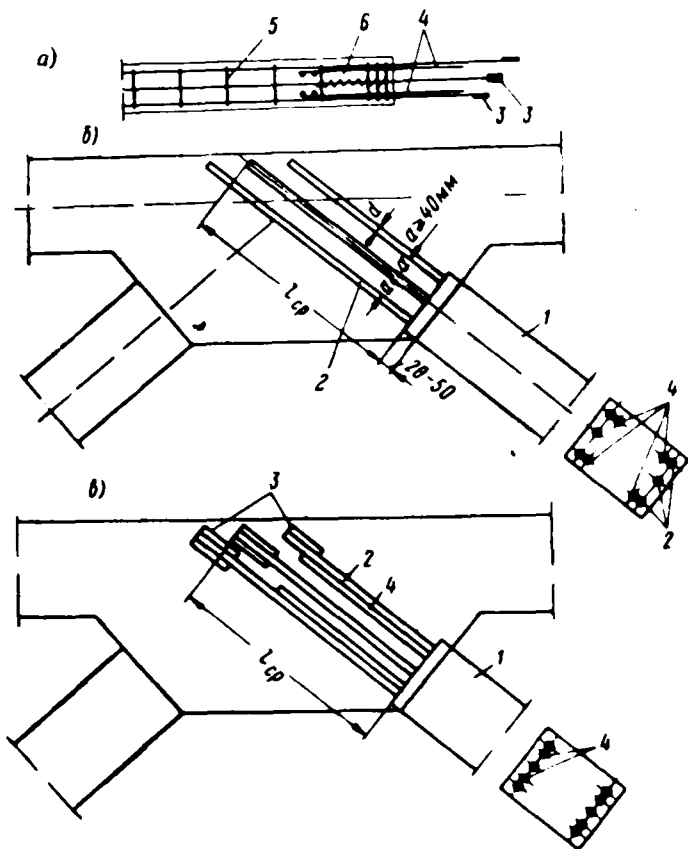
Закладные предварительно напряженные растянутые раскосы
